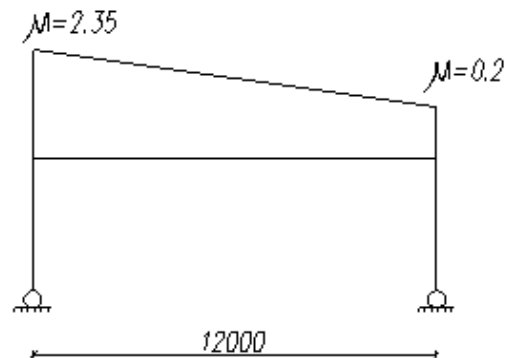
Рівномірно розподілене навантаження від ваги снігового покриття для покрівлі однопролітної секції рами за другим варіантом.
